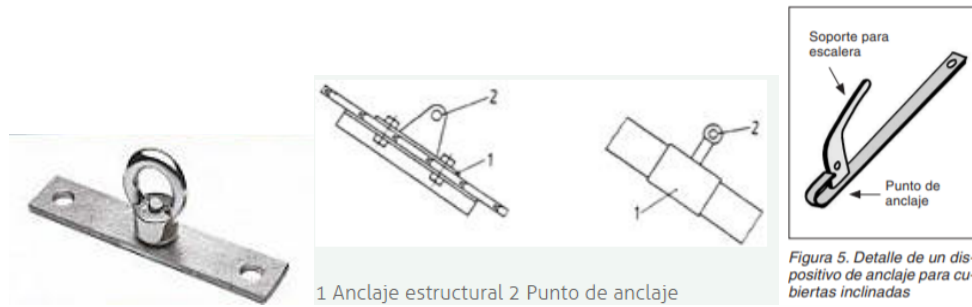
Dispositivo de anclaje sobre un tejado inclinado
